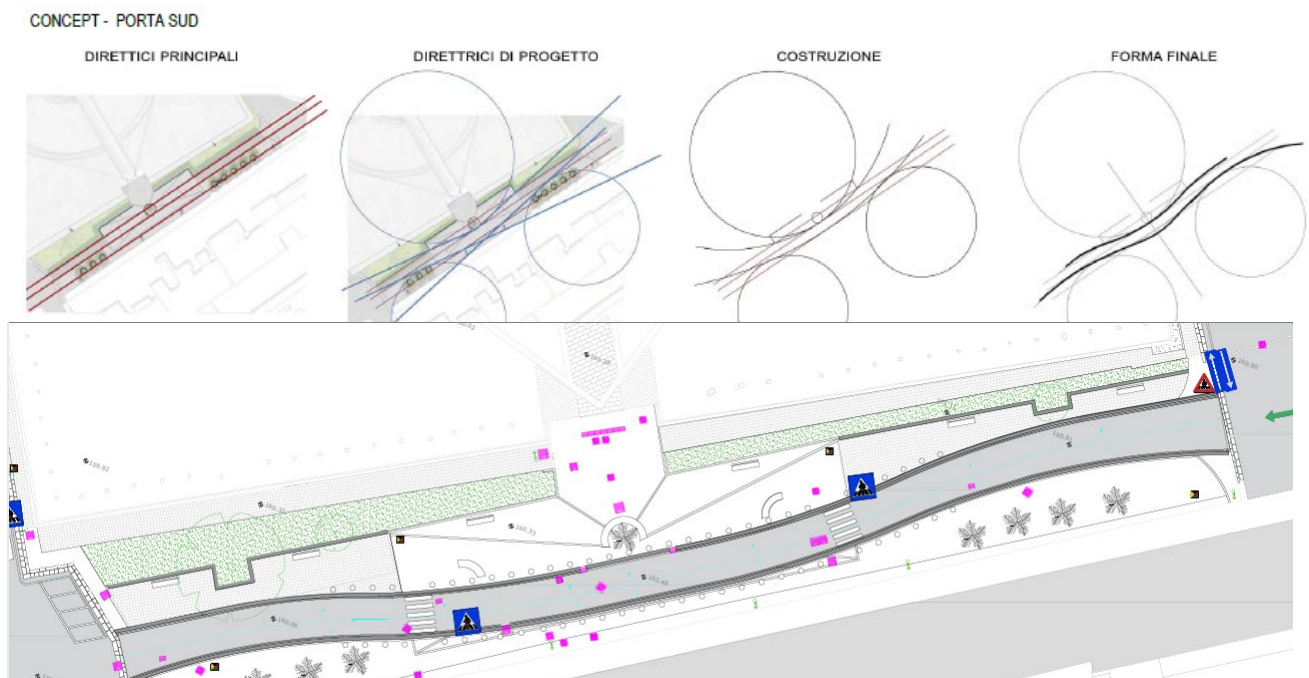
STATO DI PROGETTO – PLANIMETRIA STRADA A SUD DEL PARCO
